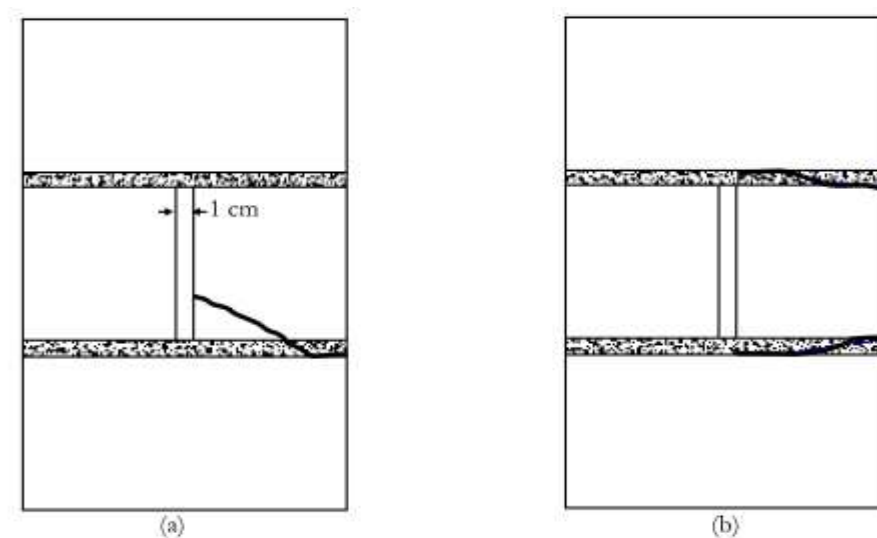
Schéma des fissurations (LAFUENTE, 1990).
